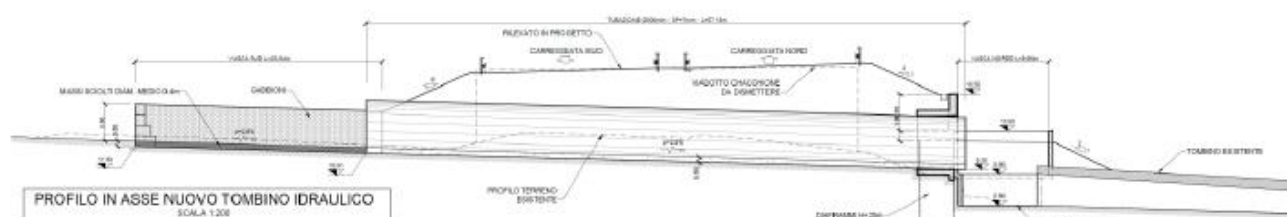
Profilo longitudinale del nuovo rilevato stradale e dell'attraversamento del fosso Cacchione
